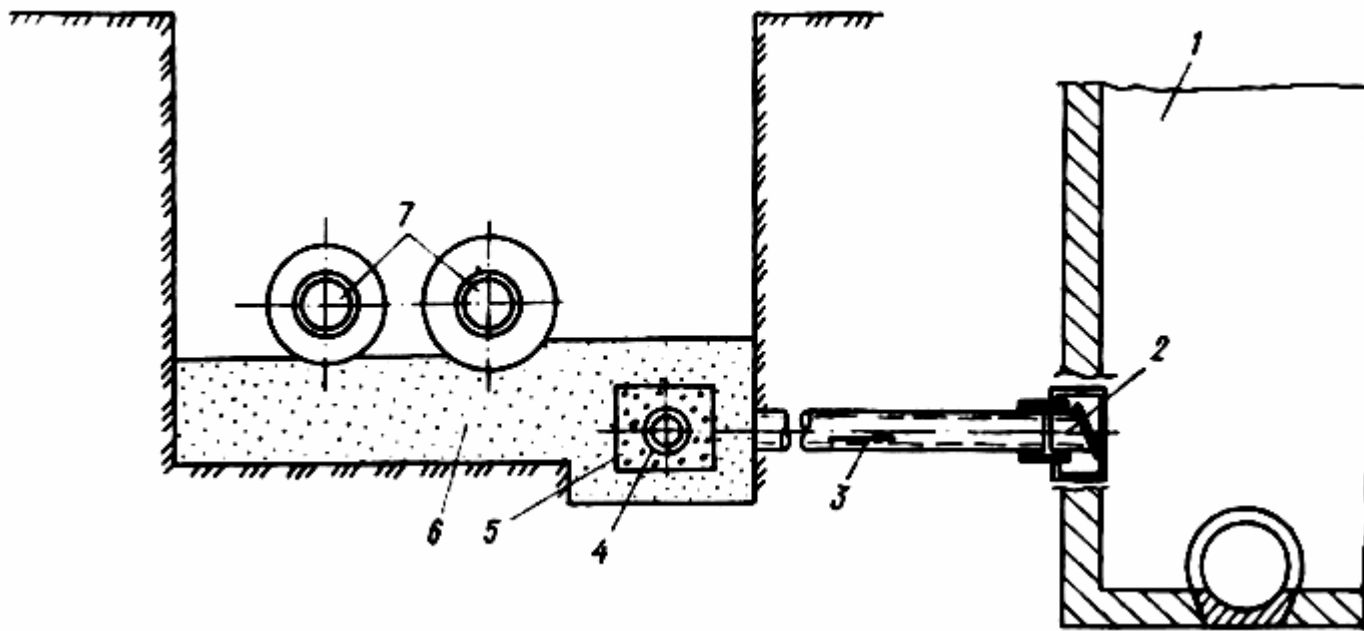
Бесканальная прокладка трубопроводов с продольным дренажом
